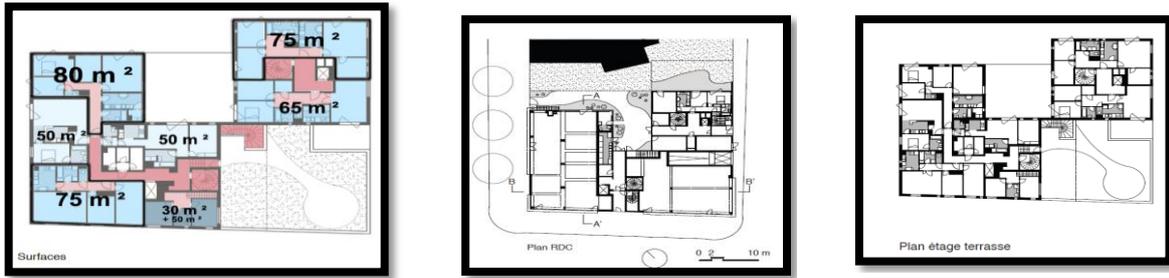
plan RDC et plan étage terrasse + les surfaces des logements
